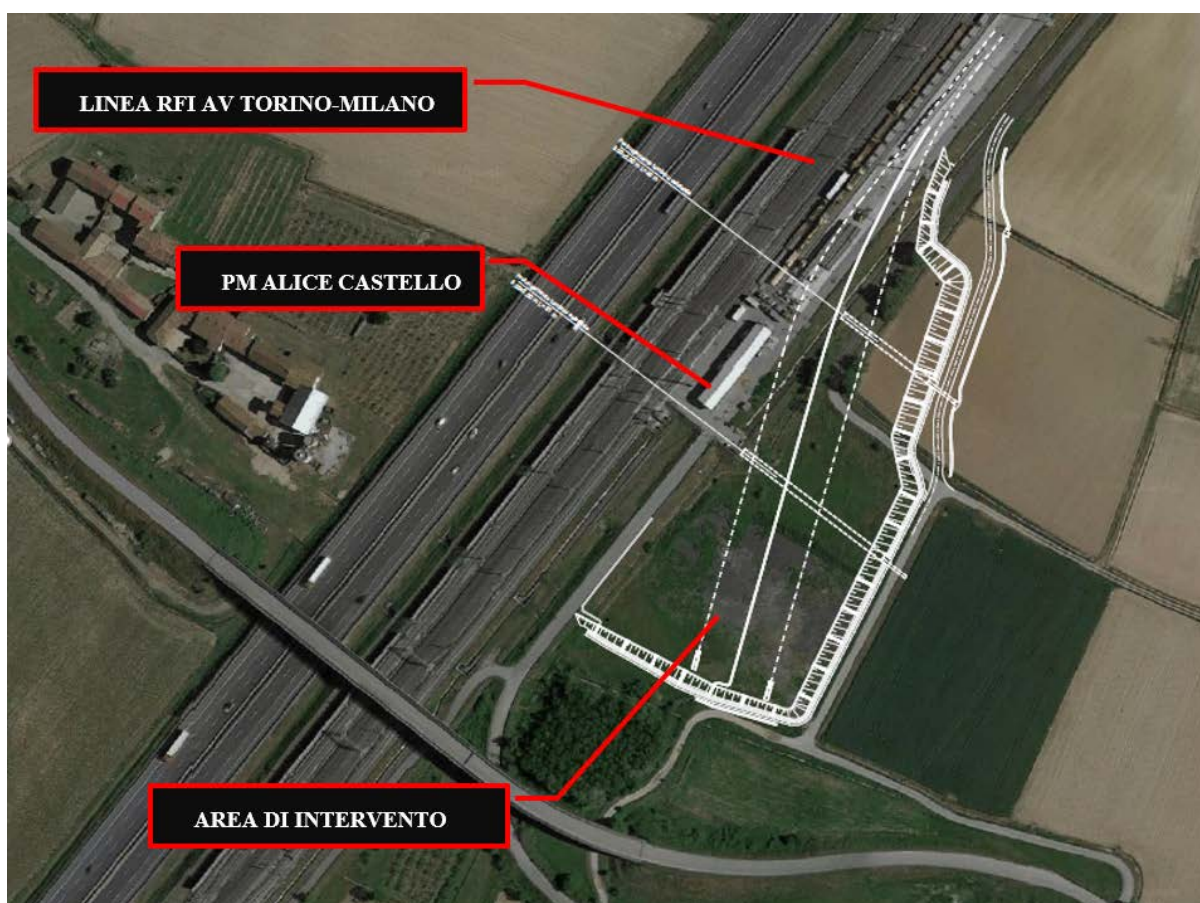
Planimetria di progetto su ortofoto (in bianco le opere di progetto)
